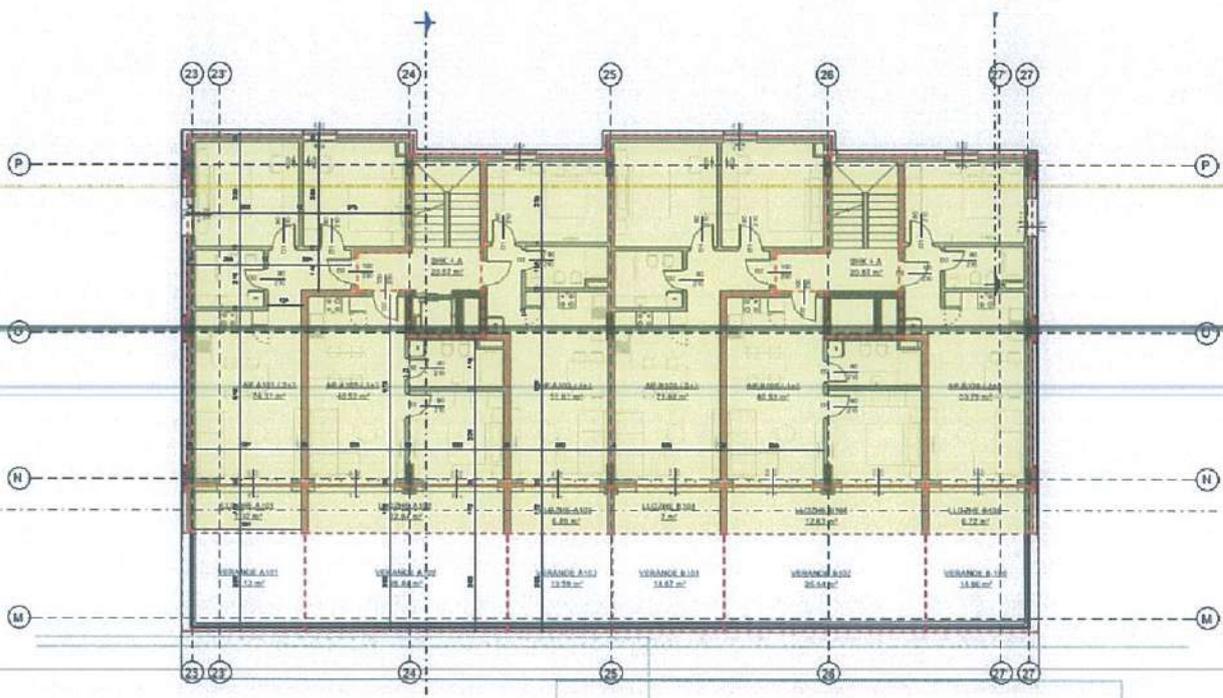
Planimetria në kuotën abs. +84.92, sipërfaqja mbitokë
